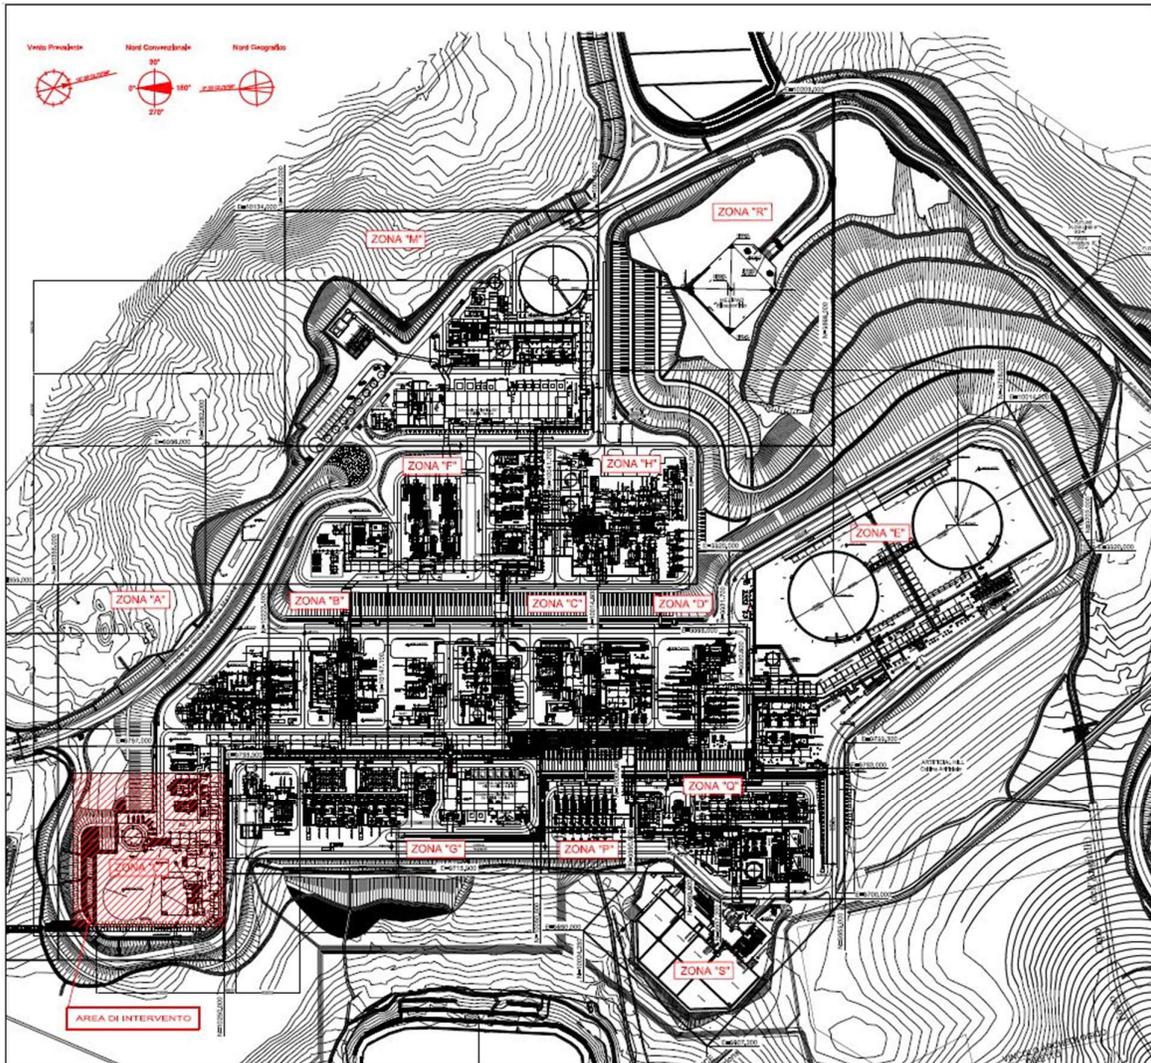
Planimetria generale del COTR con l'ubicazione dell'area di intervento (Zona L)
